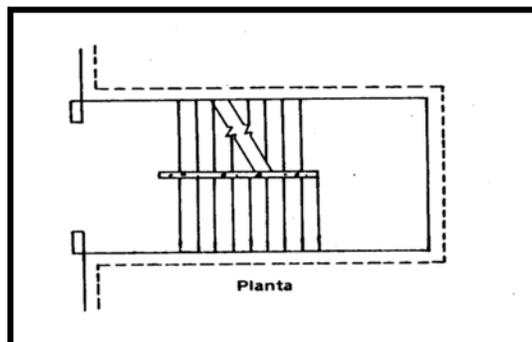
Escalera de hormigón en voladizo con muro de soporte central.
